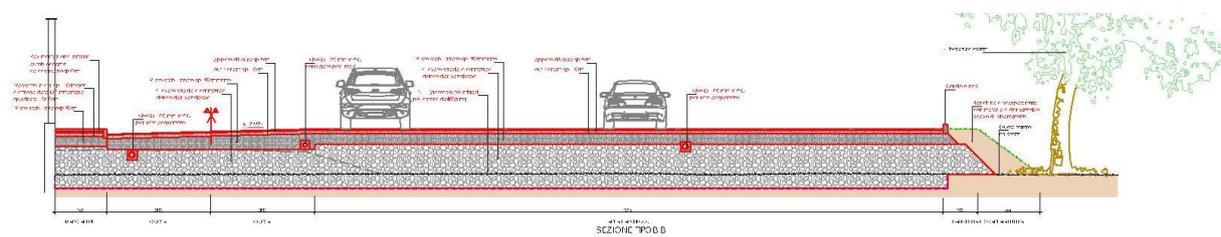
ó Sezione viabile e area parcheggio di progetto B-B
